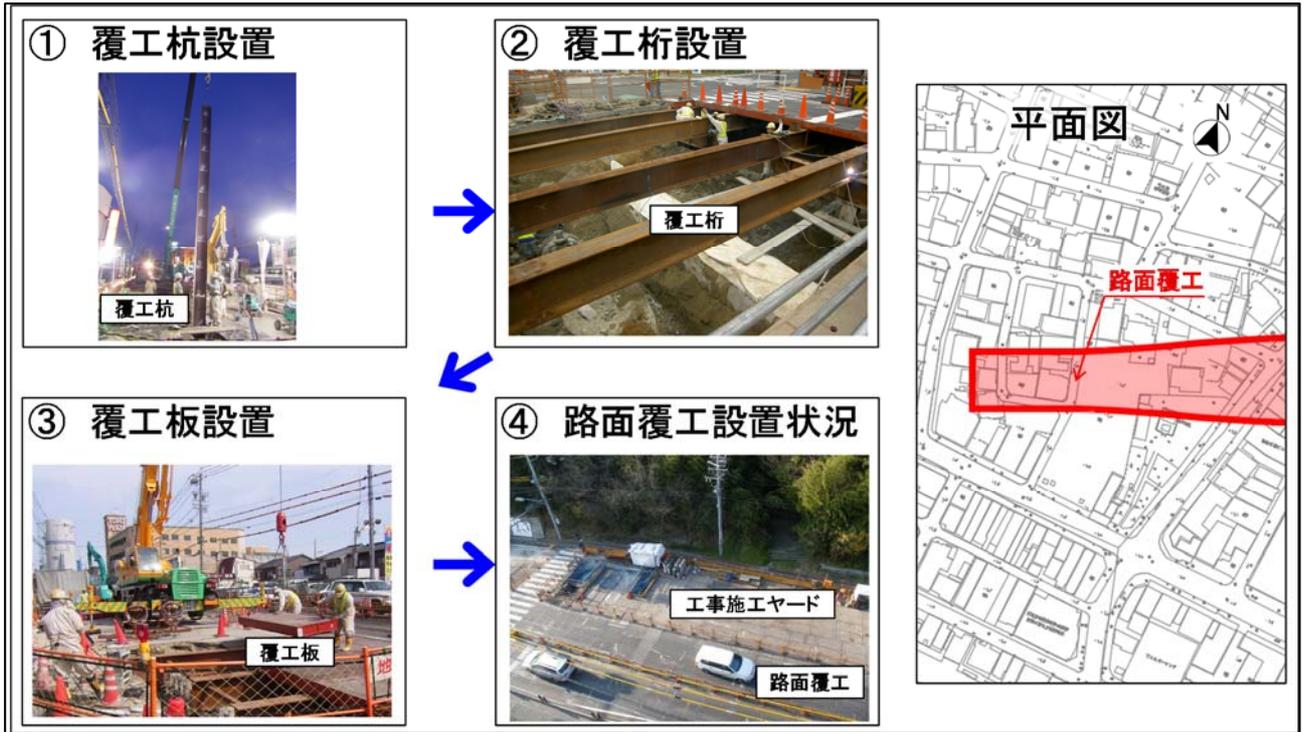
(4) 路面覆工（西工区）の施工位置及び手順
